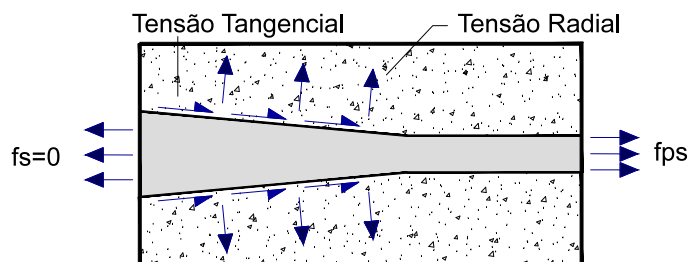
Efeito de Hoyer (adaptado de [26])
